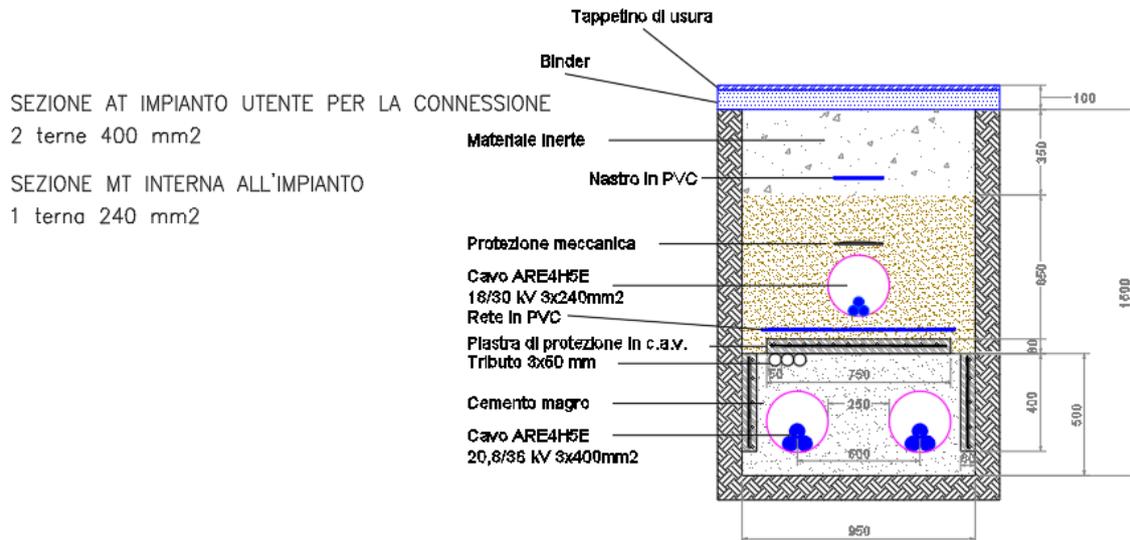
Sezione tipo MT in condivisione con linea AT su sede stradale
